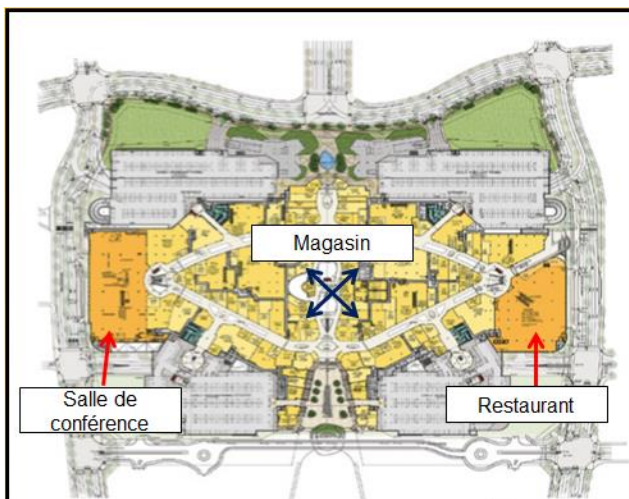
Plan 3<sup>ème</sup> étage : commerces de niveau supérieur et parking
